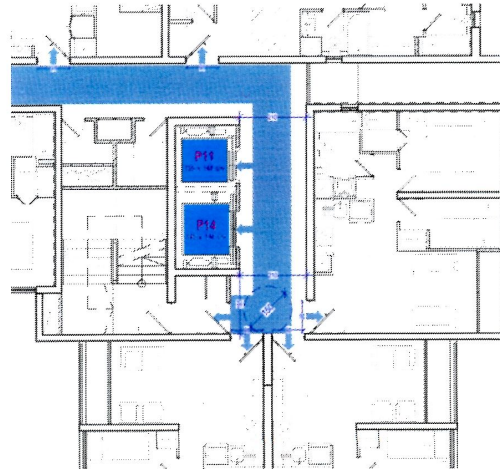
ascensores con ruta accesible universal hasta piso 13 (azotea)
